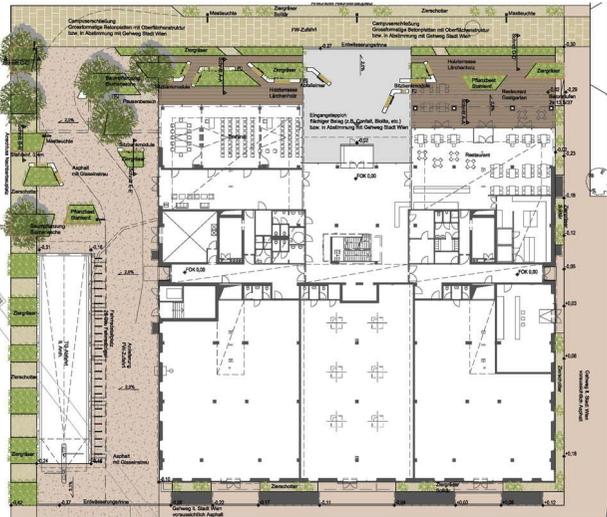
Grundriss Erdgeschoss; Quelle: ATP
